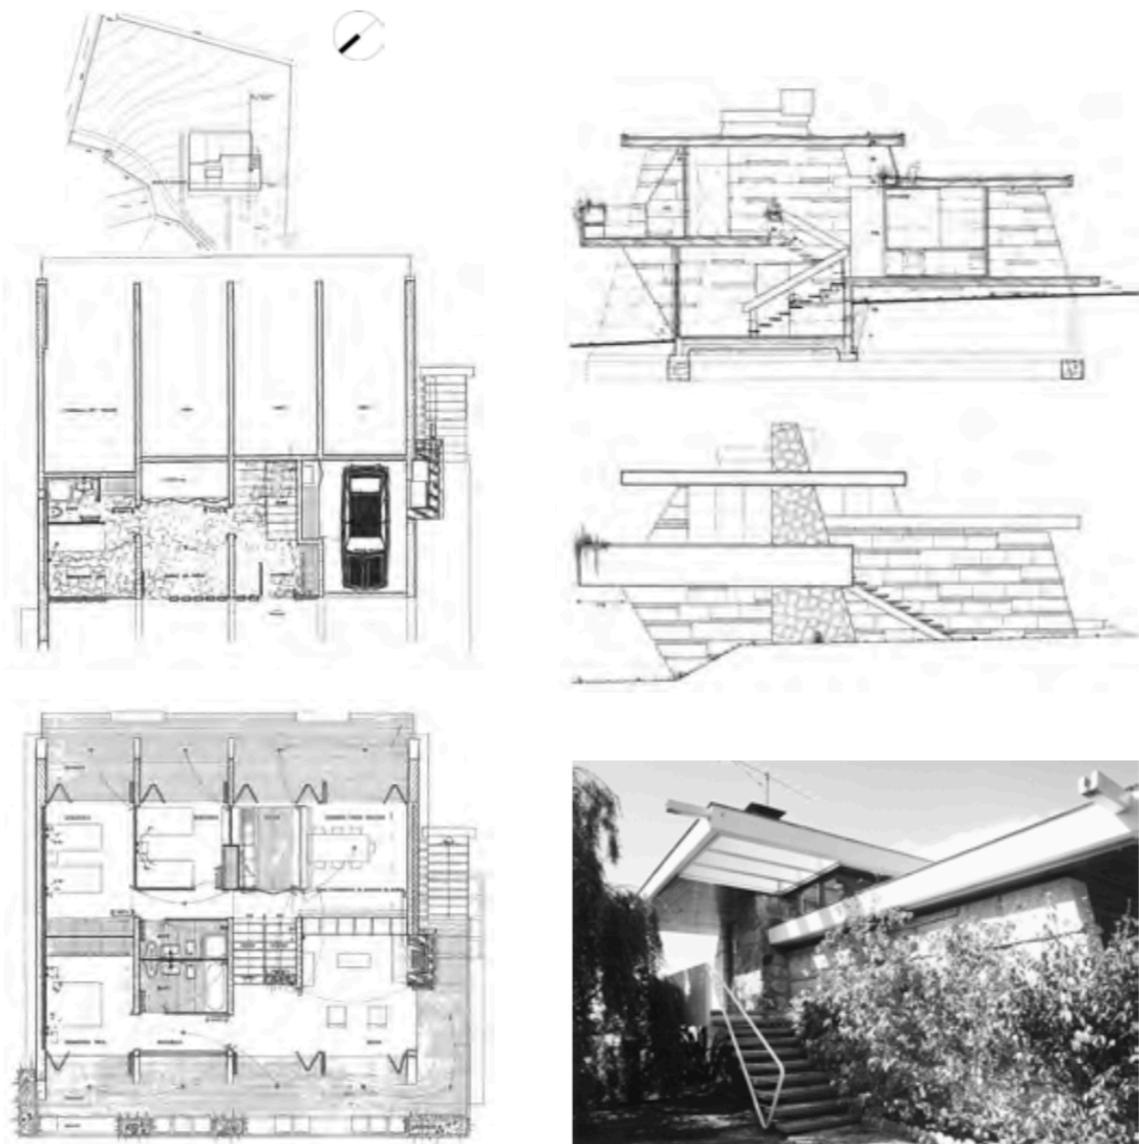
Planos casa Vázquez (Coruxo, Vigo)
